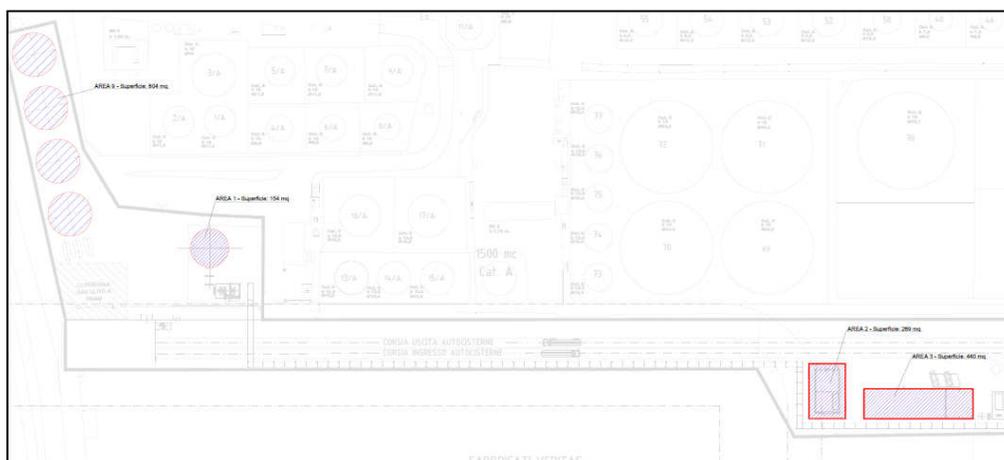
Planimetria delle Aree di Scavo a Sezione Obbligatoria per l'Area Sud dell'Impianto
